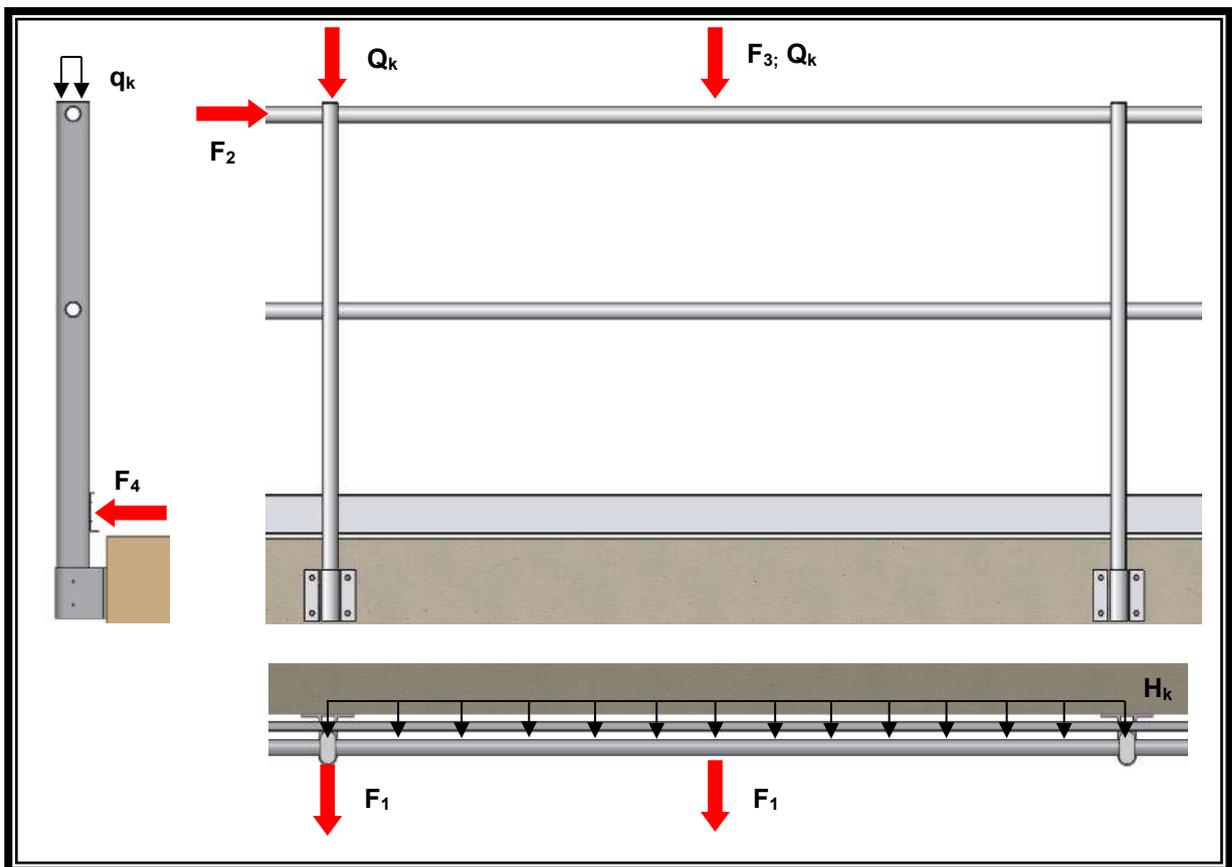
Esquema de aplicación de las cargas sobre el parapeto.
